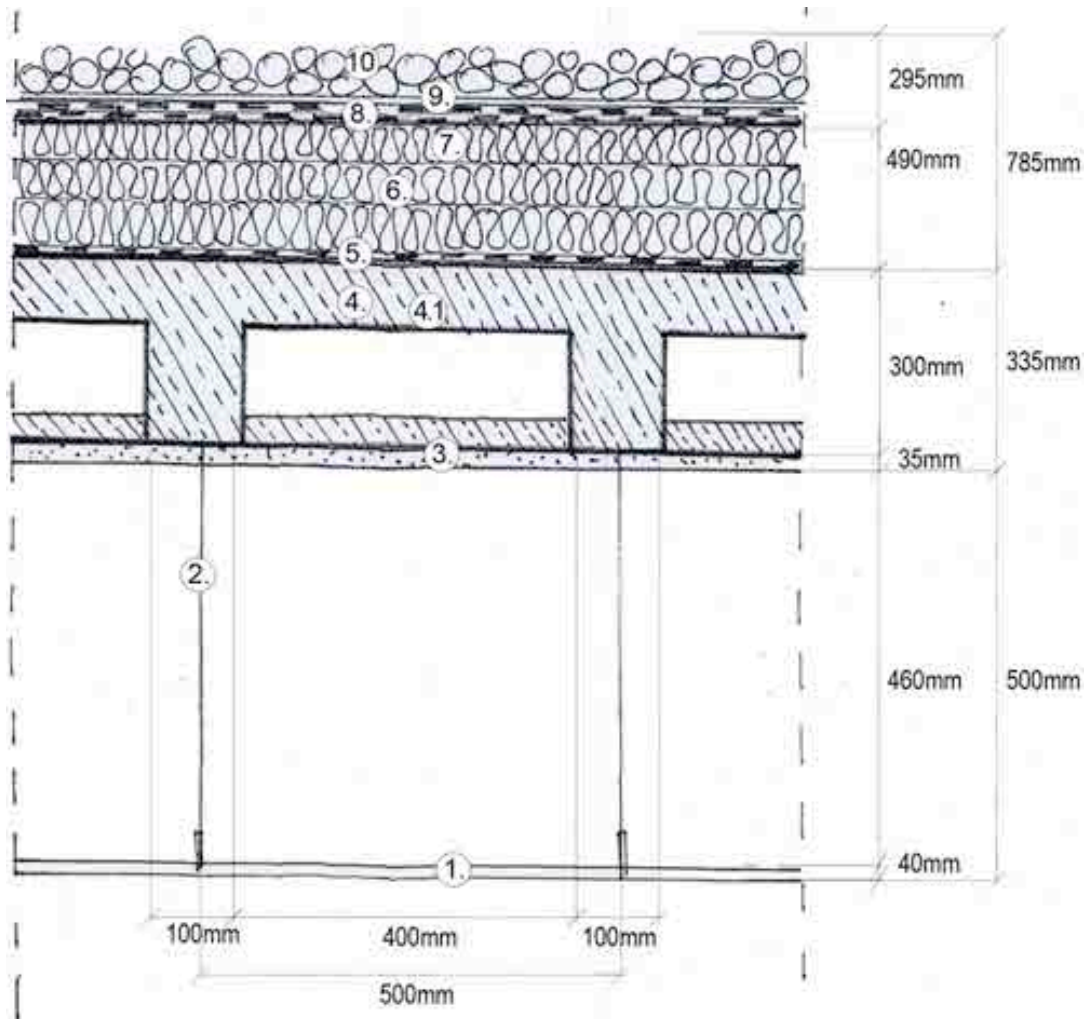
Bauteil, Dachbeläge, Decke Bestand\_30cm\_7cm
